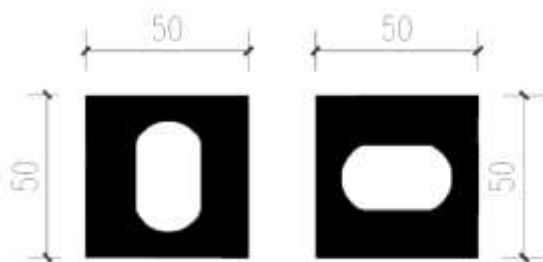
竖向、横向连接板示意图（单位：mm）
